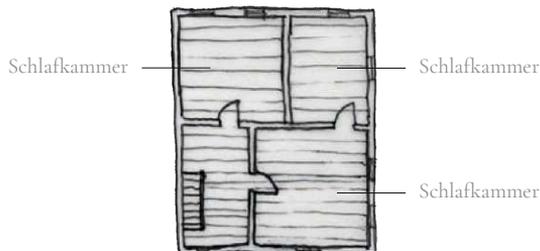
Skizze, Grundriss Obergeschoss nach 1660
